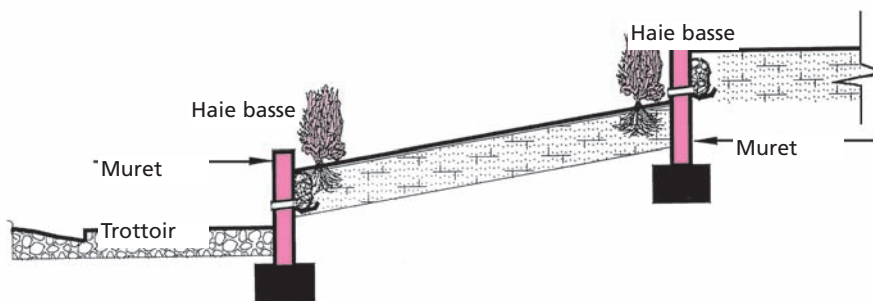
Adaptation par ressauts, murets de soutènement et haies basses
